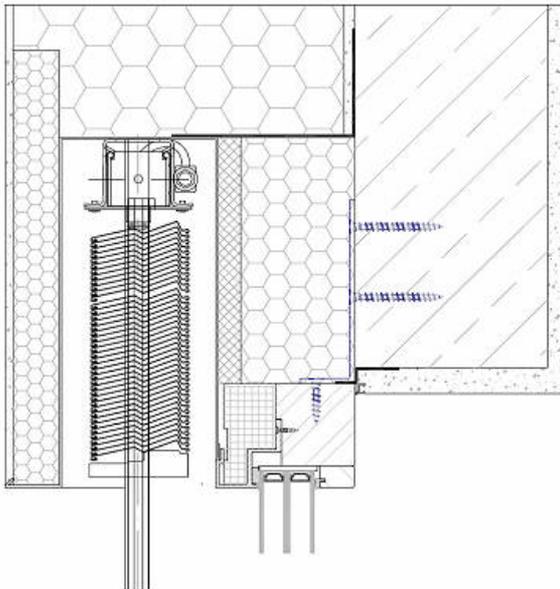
Fenstereinbau oben mit Jalousiekasten, wärmebrückenarm.
